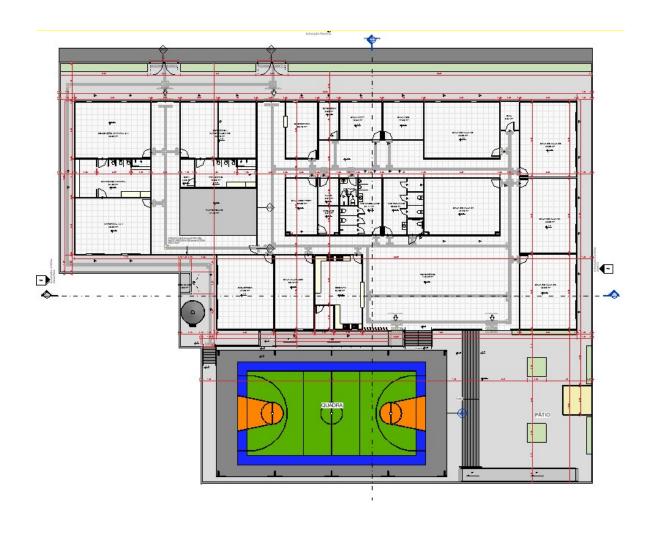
Planta Baixa de Implantação – Geral (Ampliada)
